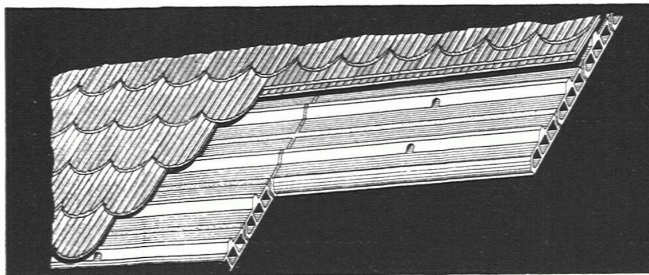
Unterdachkonstruktion in Dachhourdis.
